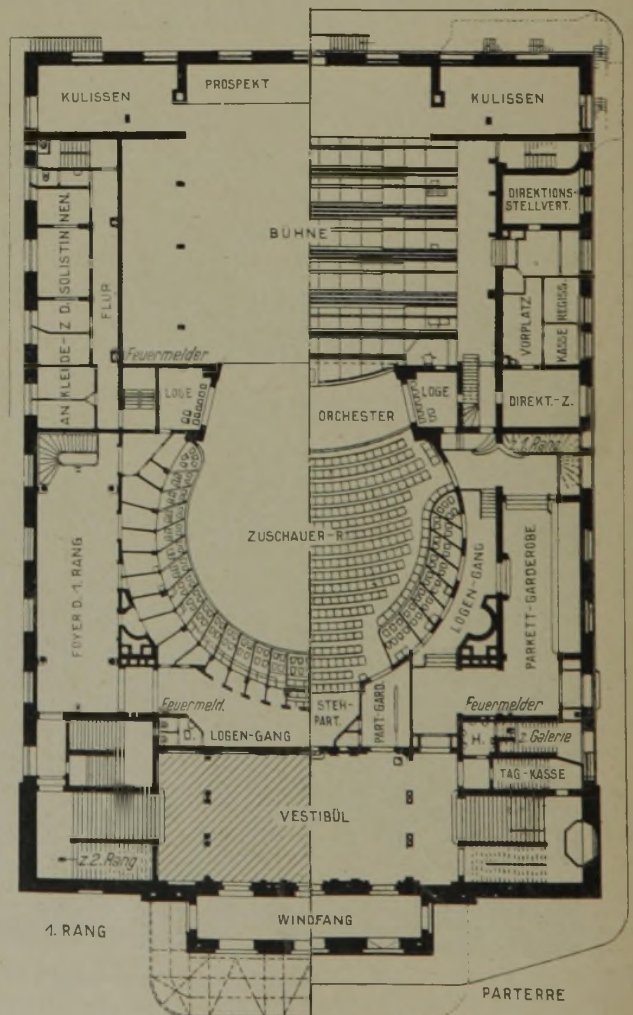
u. 6. Grundrisse der Ränge.
